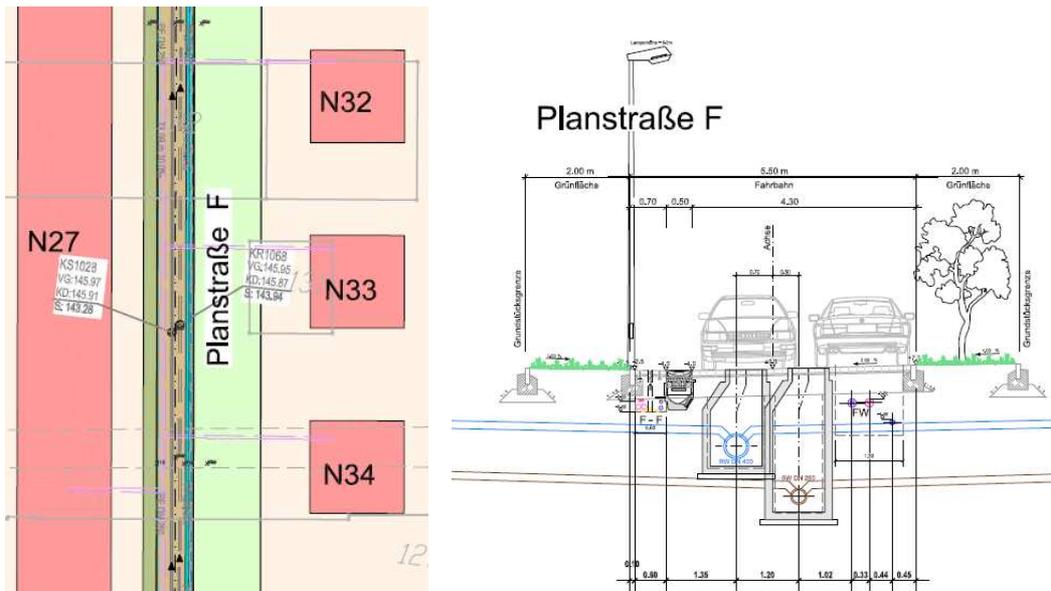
und 17: Bit Consult GmbH, Friolzheimer Straße 3, 70499 Stuttgart: Ausschnitt aus dem Masterplan, Stand 21.02.2011 sowie aus dem Plan: Regelquerschnitt, Stand 04.03.2011
